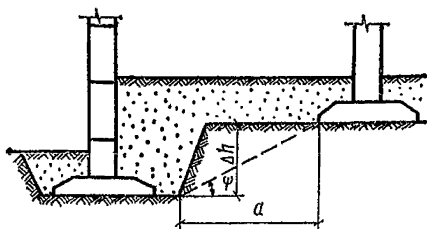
Схема заложения соседних фундаментов на различной глубине
